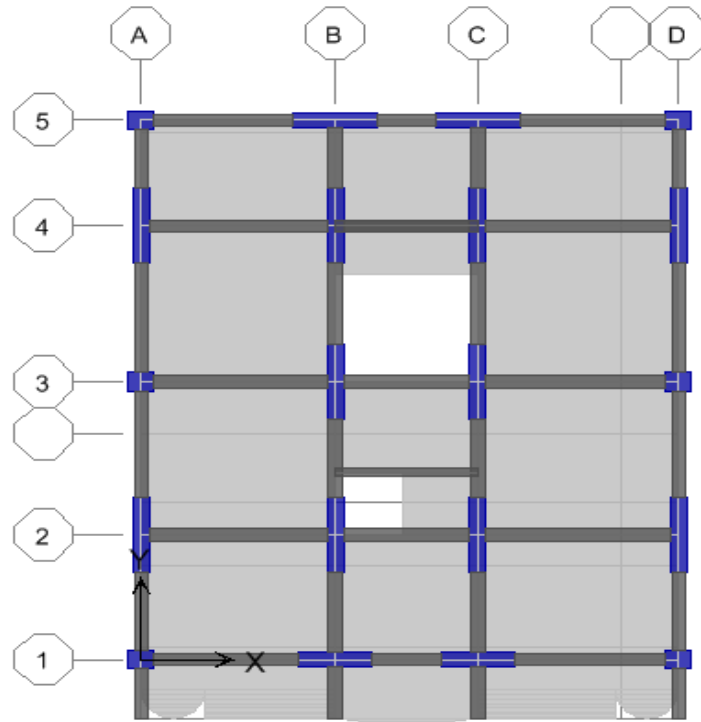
Vue en plan du 3<sup>ème</sup> système
